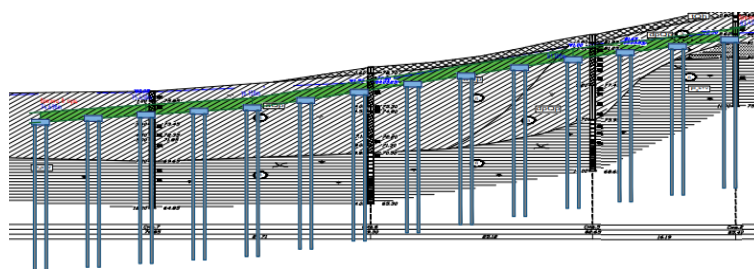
Вертикальная привязка буроналивных свай ЭРТ и монолитных железобетонных ростверков по напорный трубопровод  $d=1020,0$  мм.
